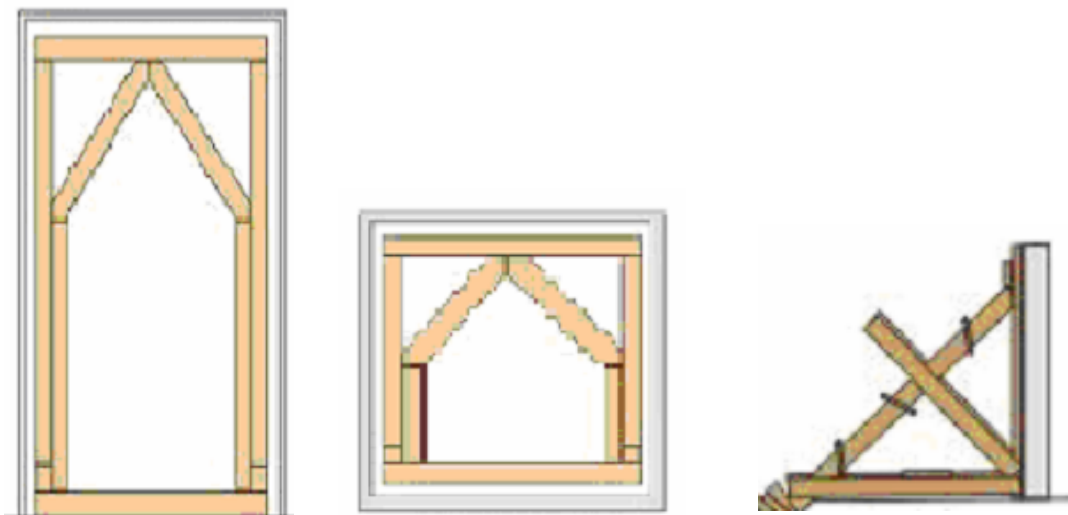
Escoramento em madeira para porta, janela e fachada [4]
